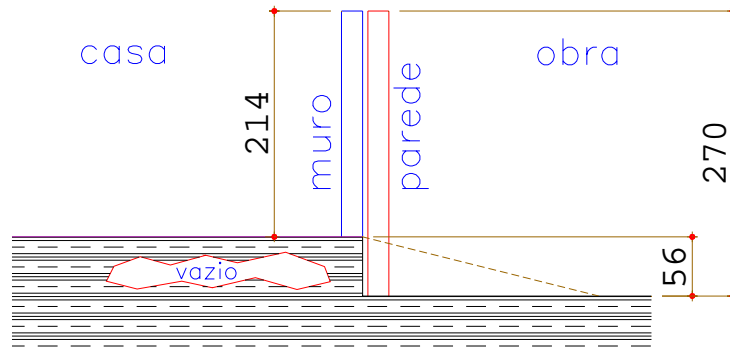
O solo desmoronado foi retirado, abrindo espaço para a construção da parede posterior da parte 2 da obra.
